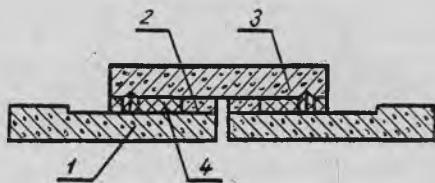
Жесткий стык сборного железобетонного напорного трубопровода:
